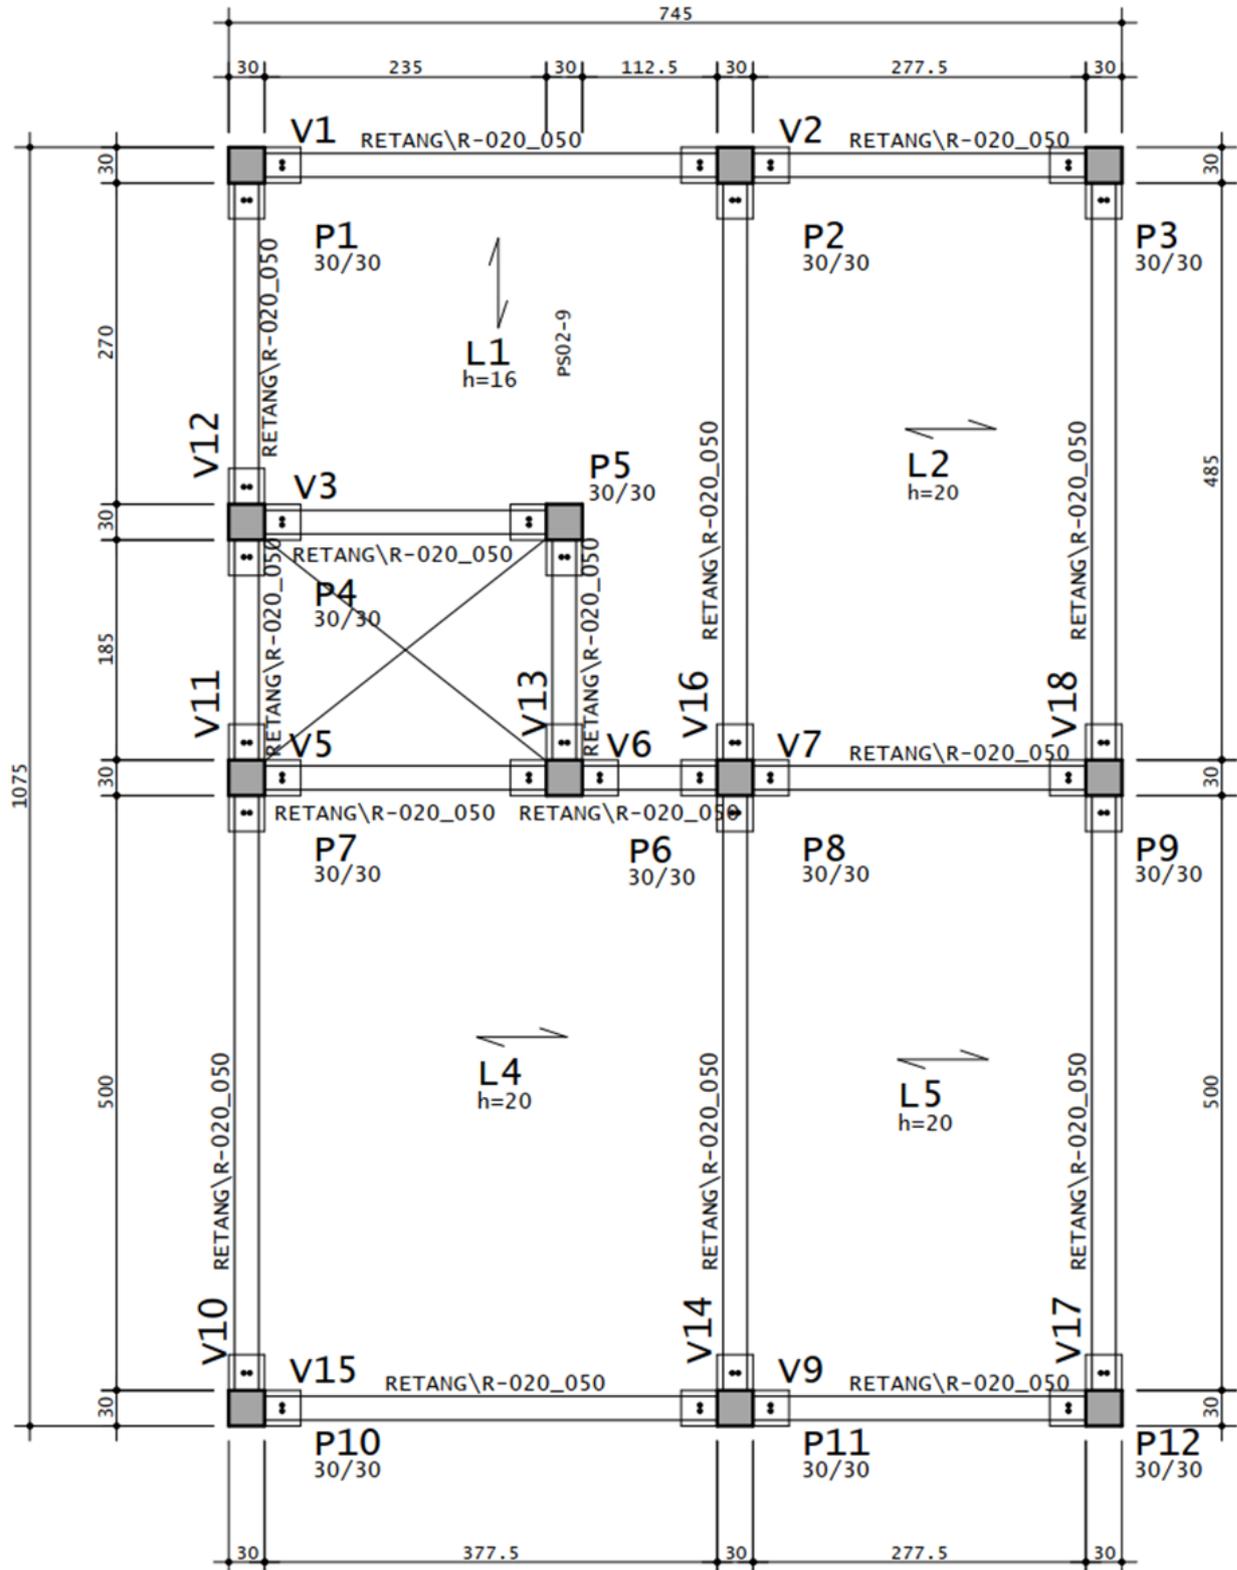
Planta de forma da cobertura da estrutura pré-fabricada (nível +6,00)
